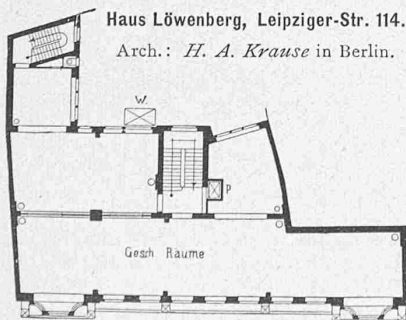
Grundriss vom II. Obergeschoss 1:500.
